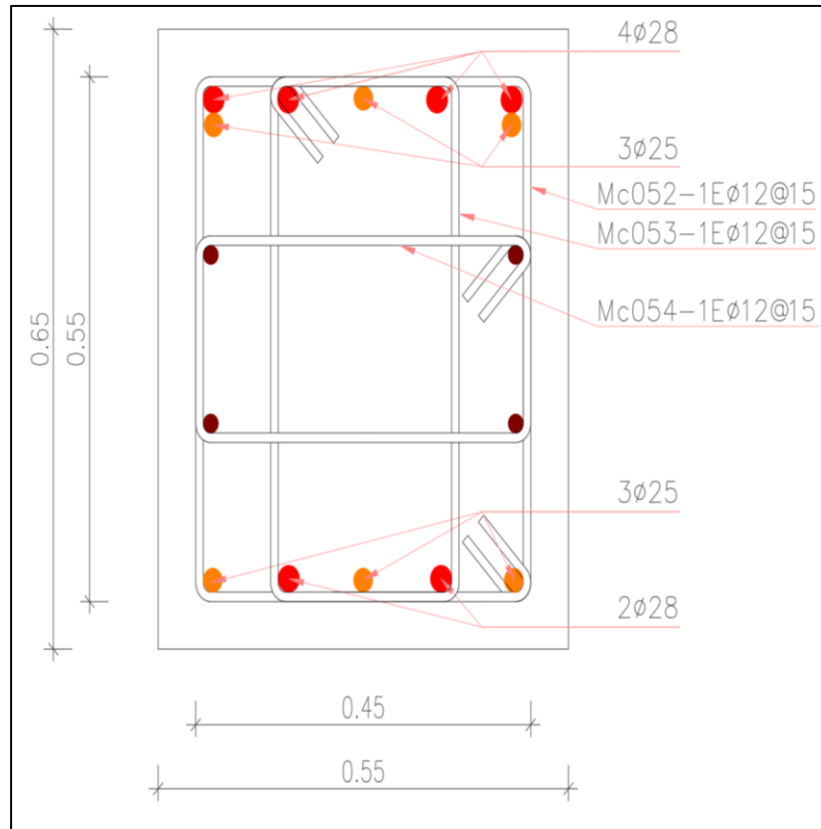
Diseño definitivo de la sección transversal de la viga longitudinal. Fuente: Autor
